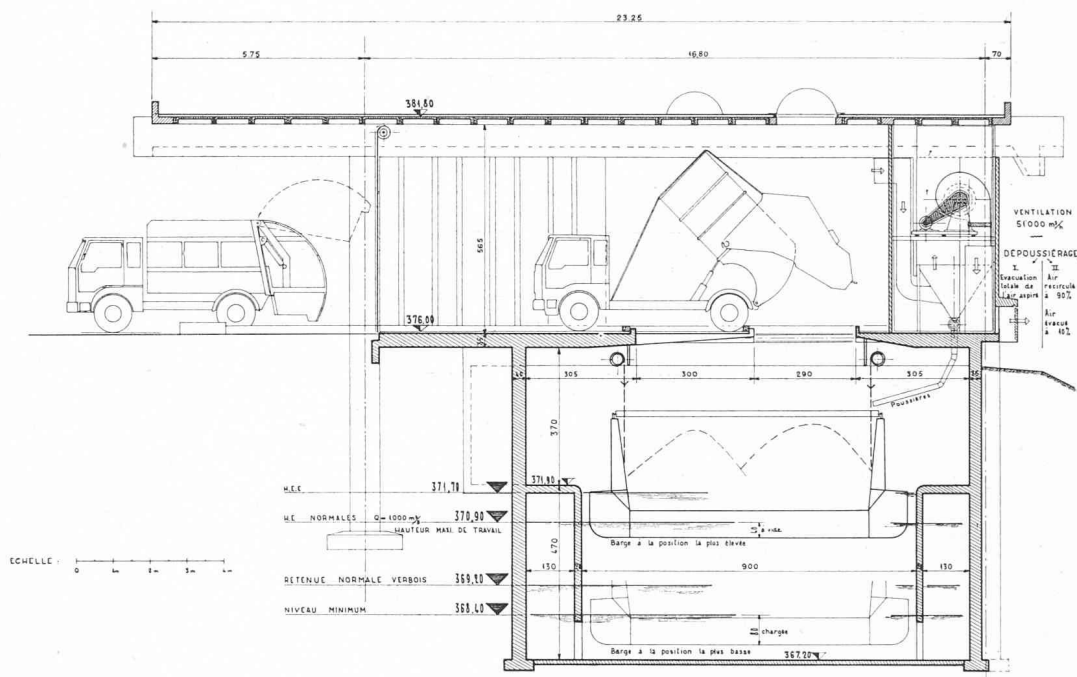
Bâtiment de chargement. Coupe en travers.
